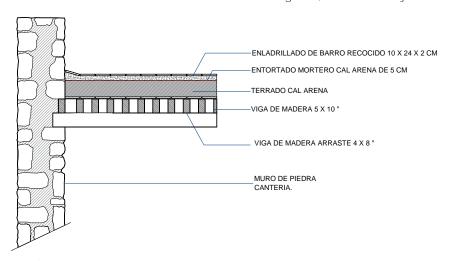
Detalle No. 2 vista del corte de la cubierta mostrando la viguería, el enladrillado y el terrado.
